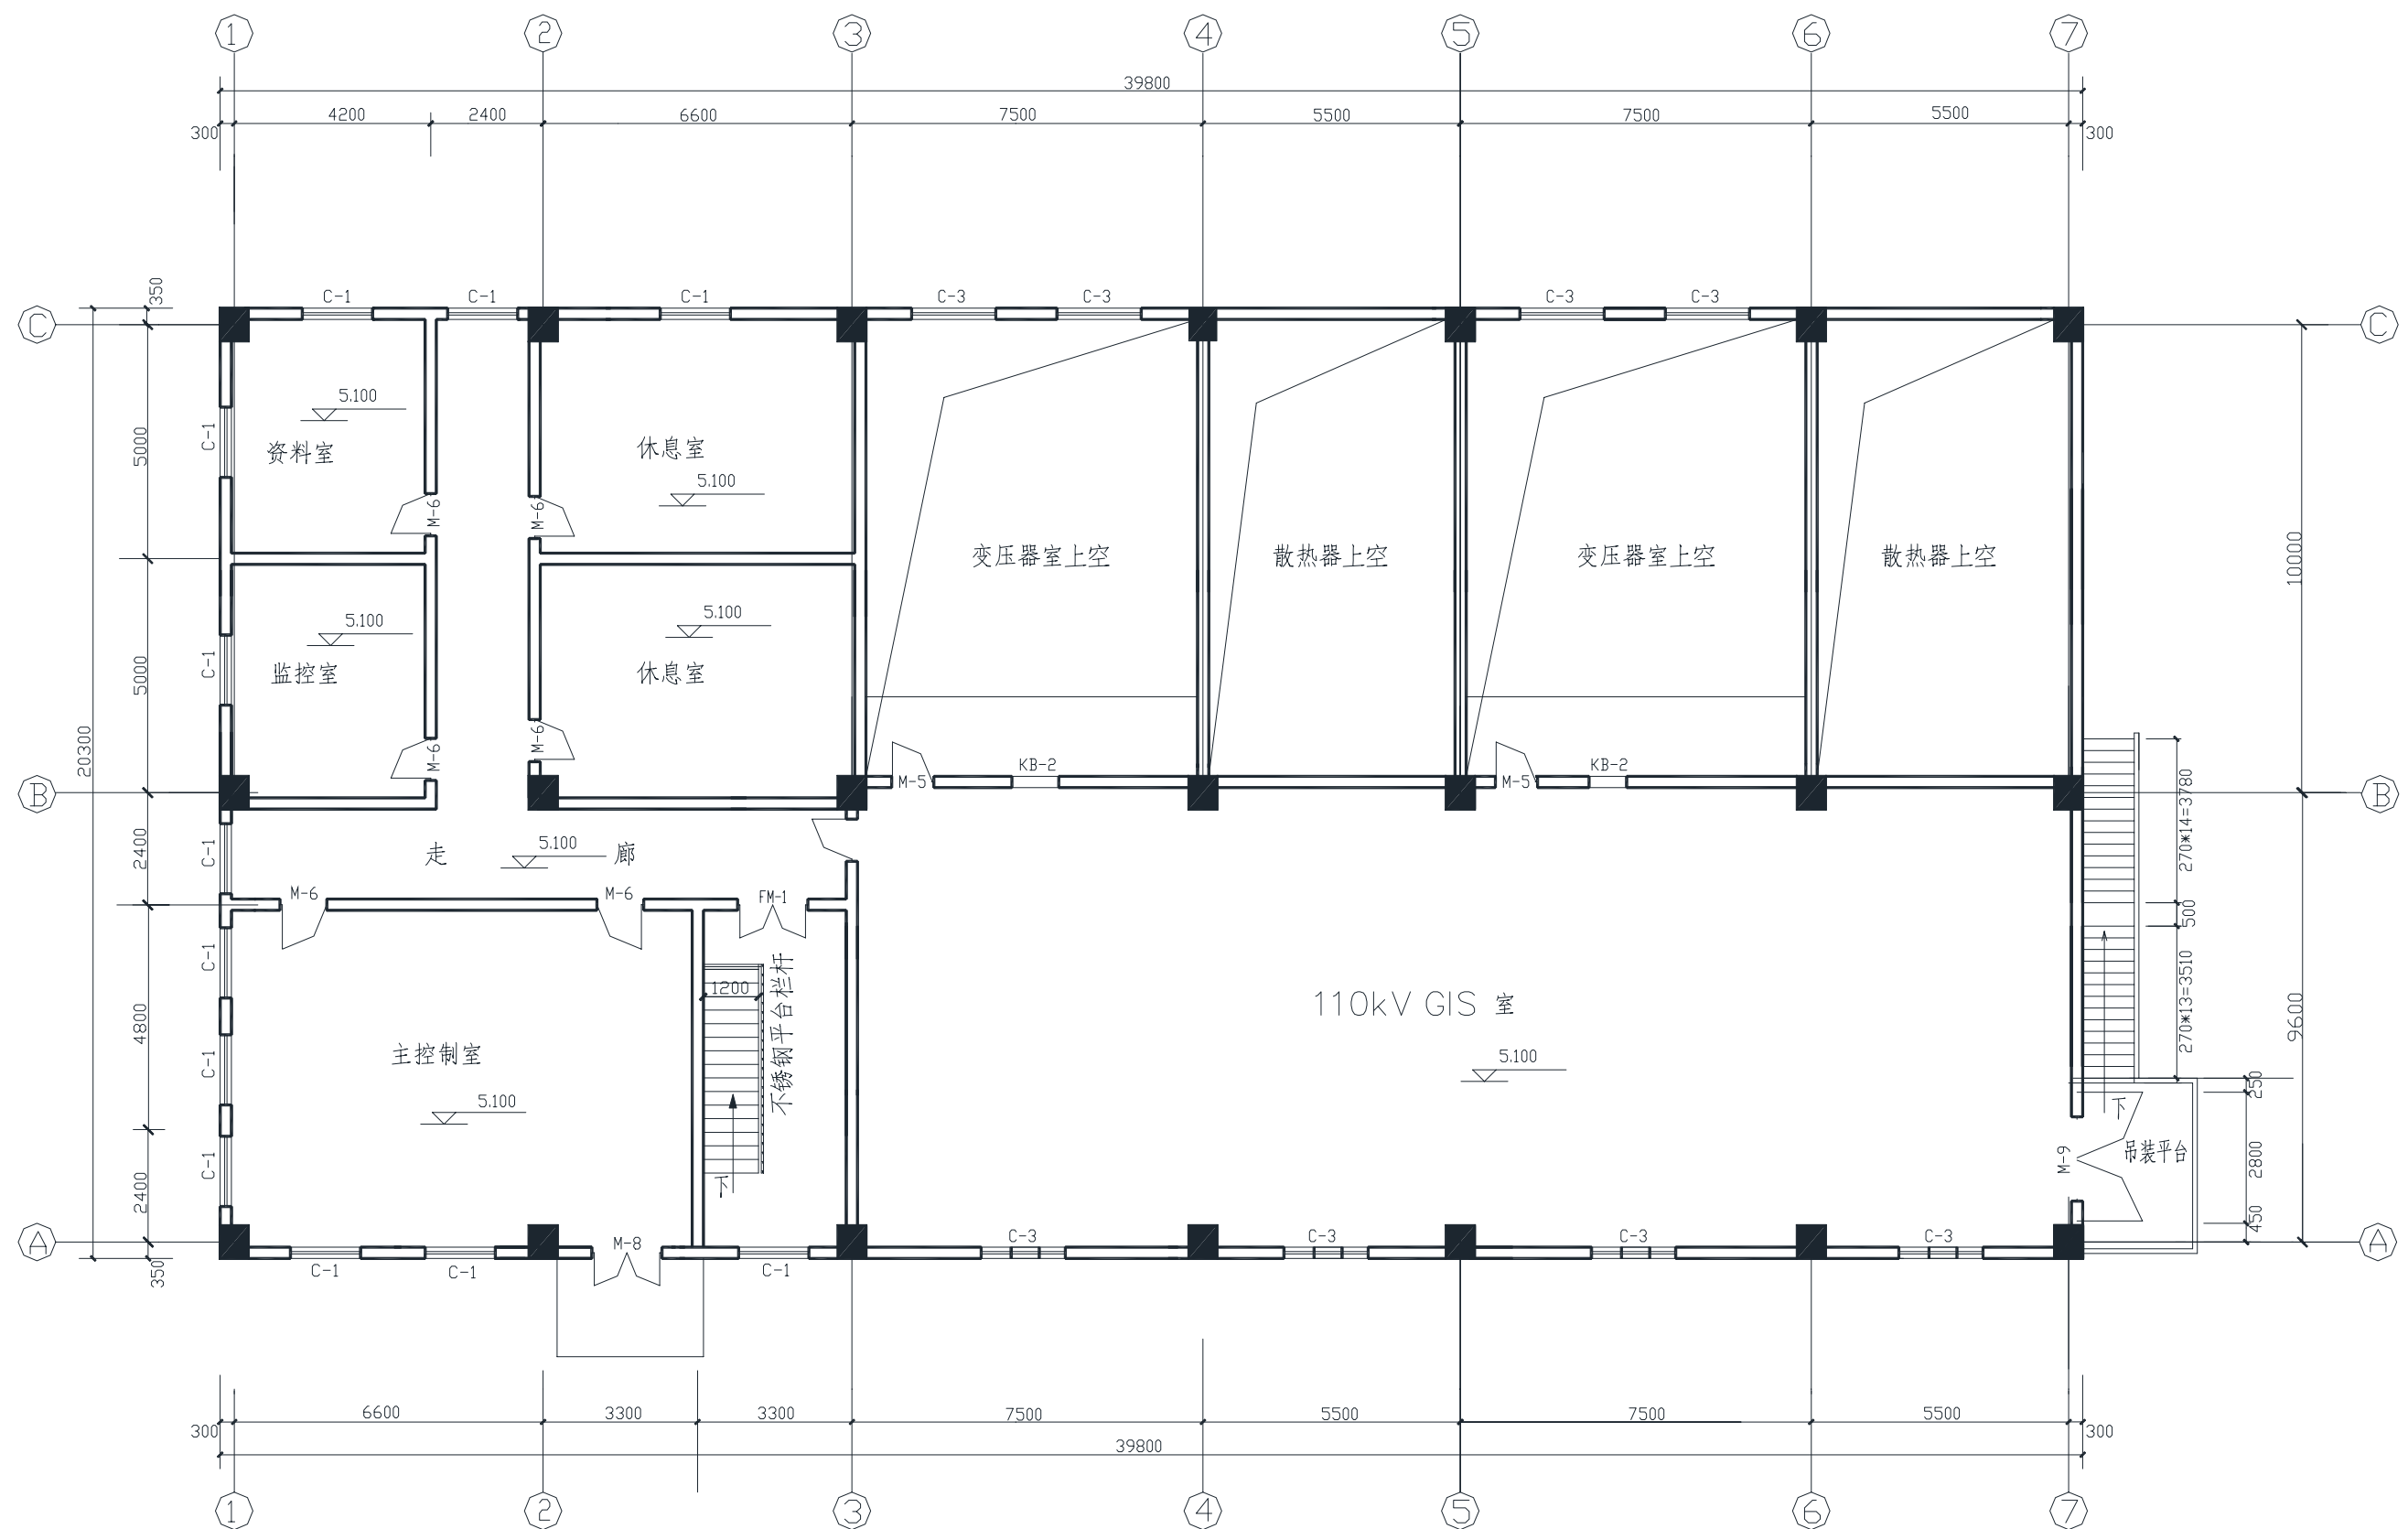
综合配电楼二层平面布置图(A2-2-07)
